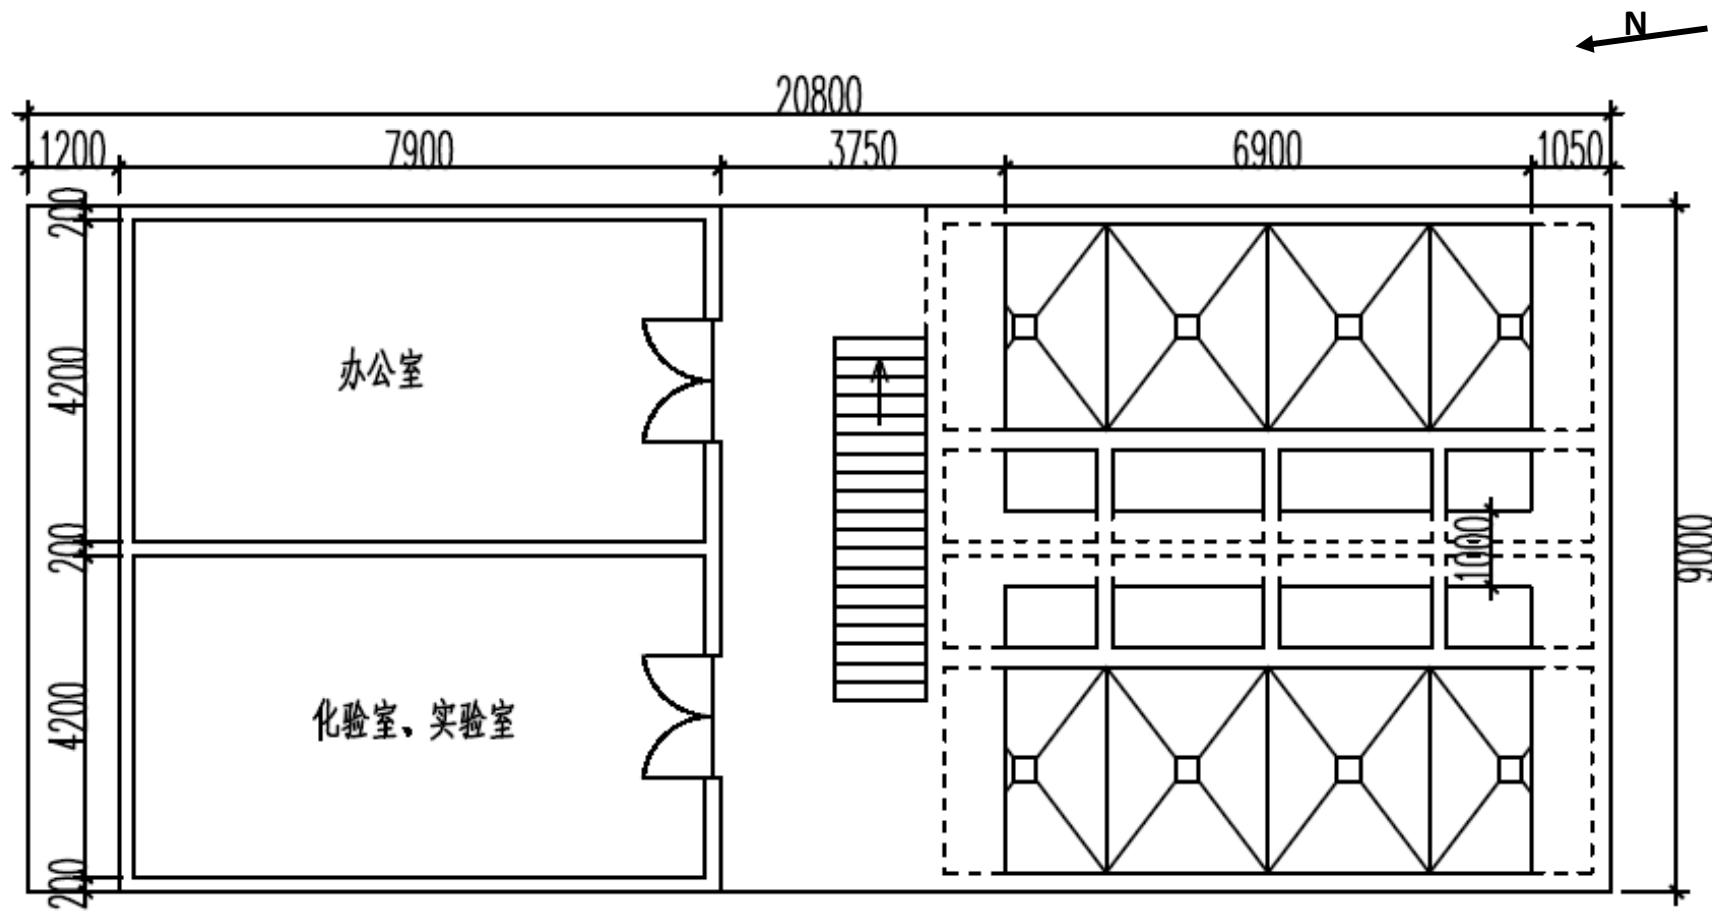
处理构筑物2四层平面布置图（9.8~13m）
